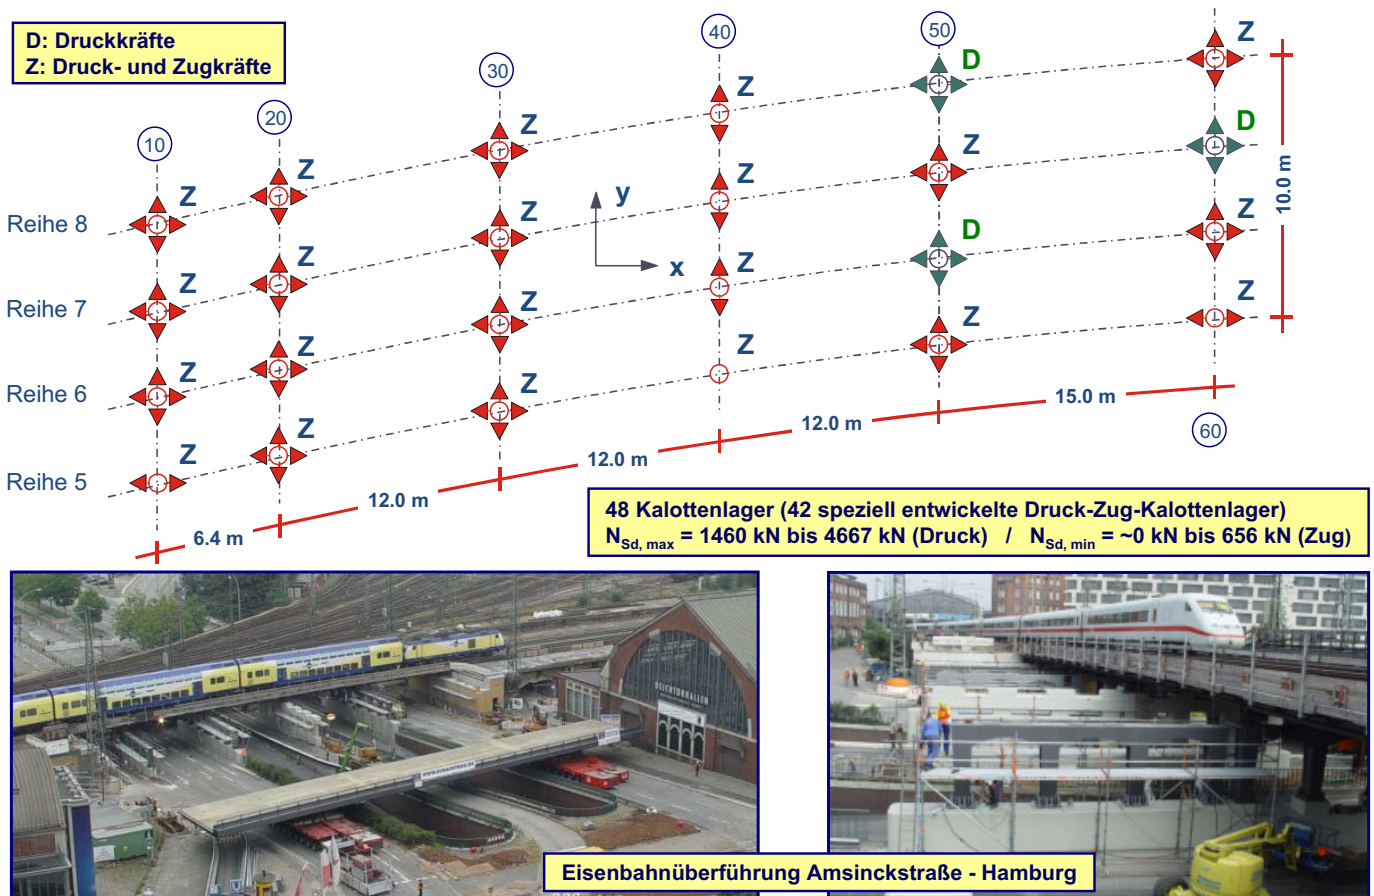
Eisenbahnüberführung Amsinckstraße/Lagerungssystem (Überbau 2)
